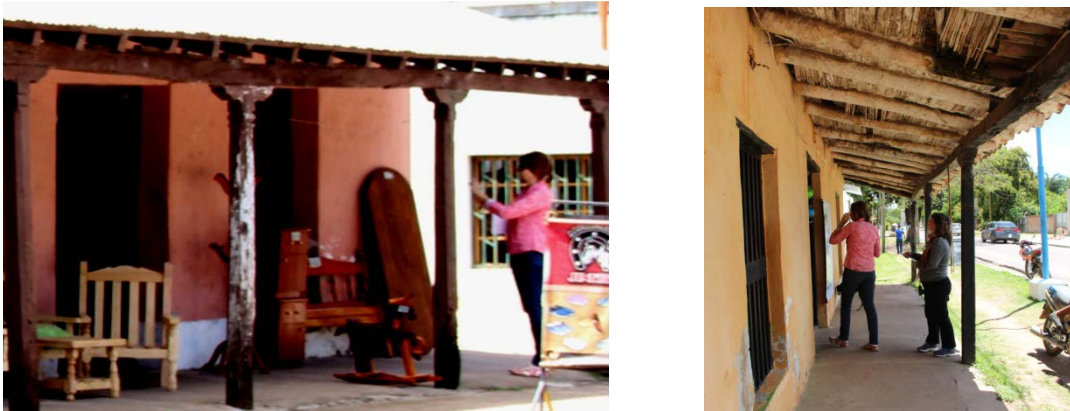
Relevamientos de viviendas con galería en poblados correntinos (Foto: ASN- CEHAU)
